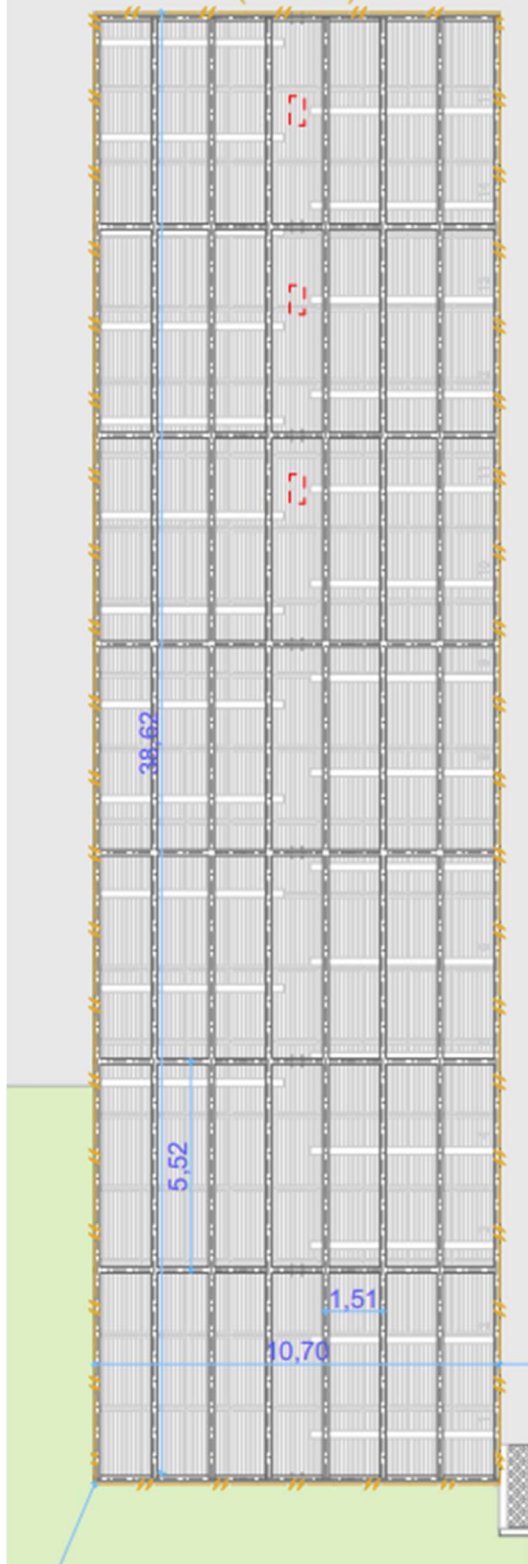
Plan de masse toiture Ombrière Véhicules légers
